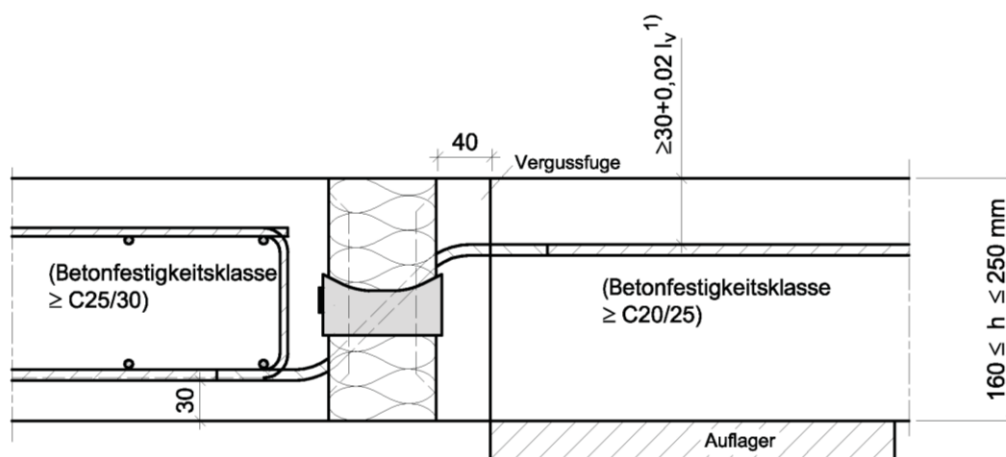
Schöck Isokorb Typ RQ-240 in eingebautem Zustand mit Vergussfuge
